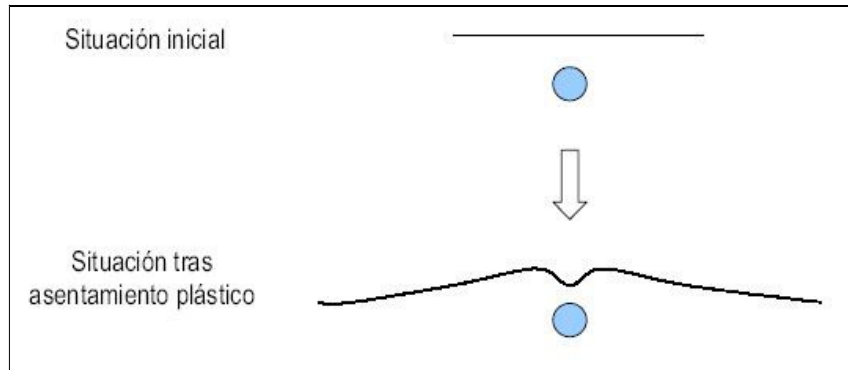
Fisuración por Asentamiento.²²
